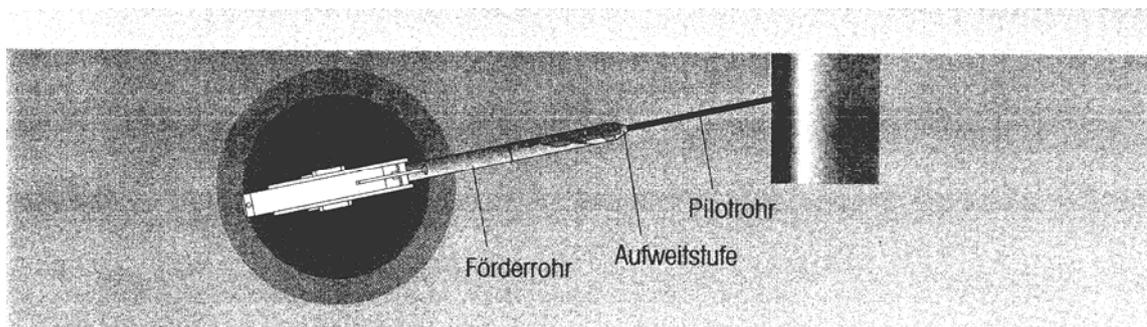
Aufweitstufe mit Förderschnecke am Pilotrohr geführt [1]
